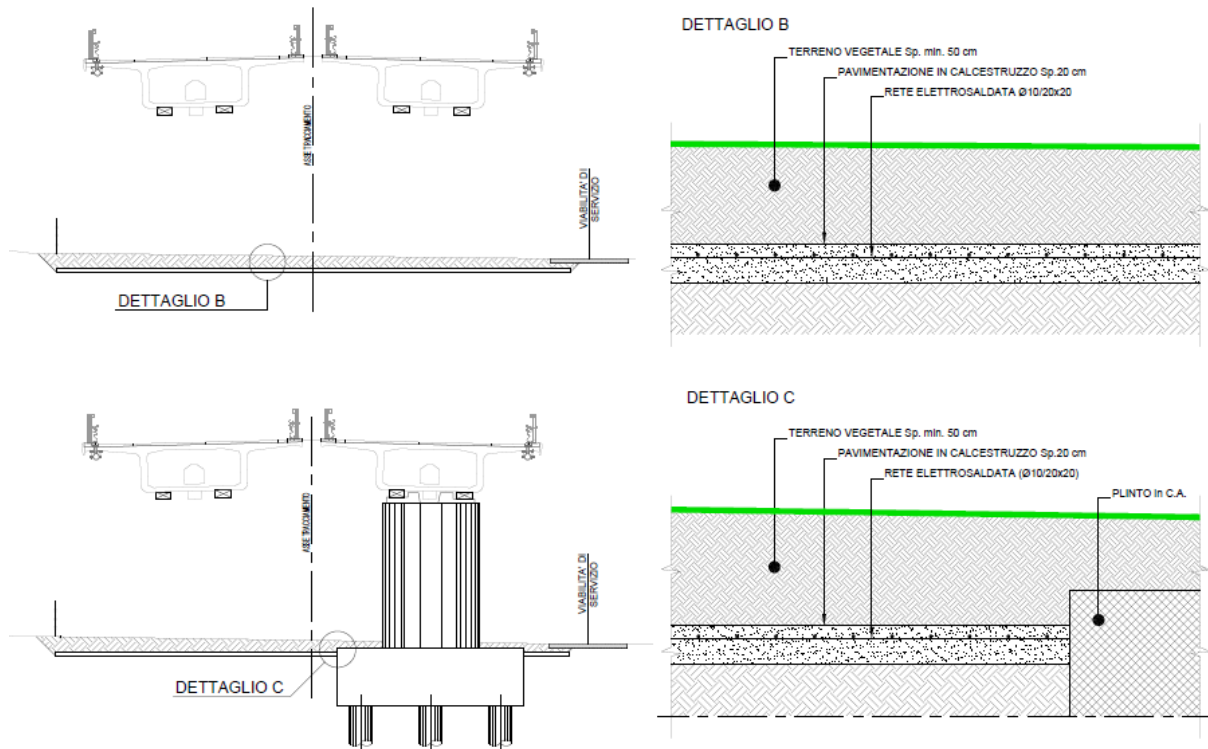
Sezione tipo pavimentazione presso interferenza poligono S0771
